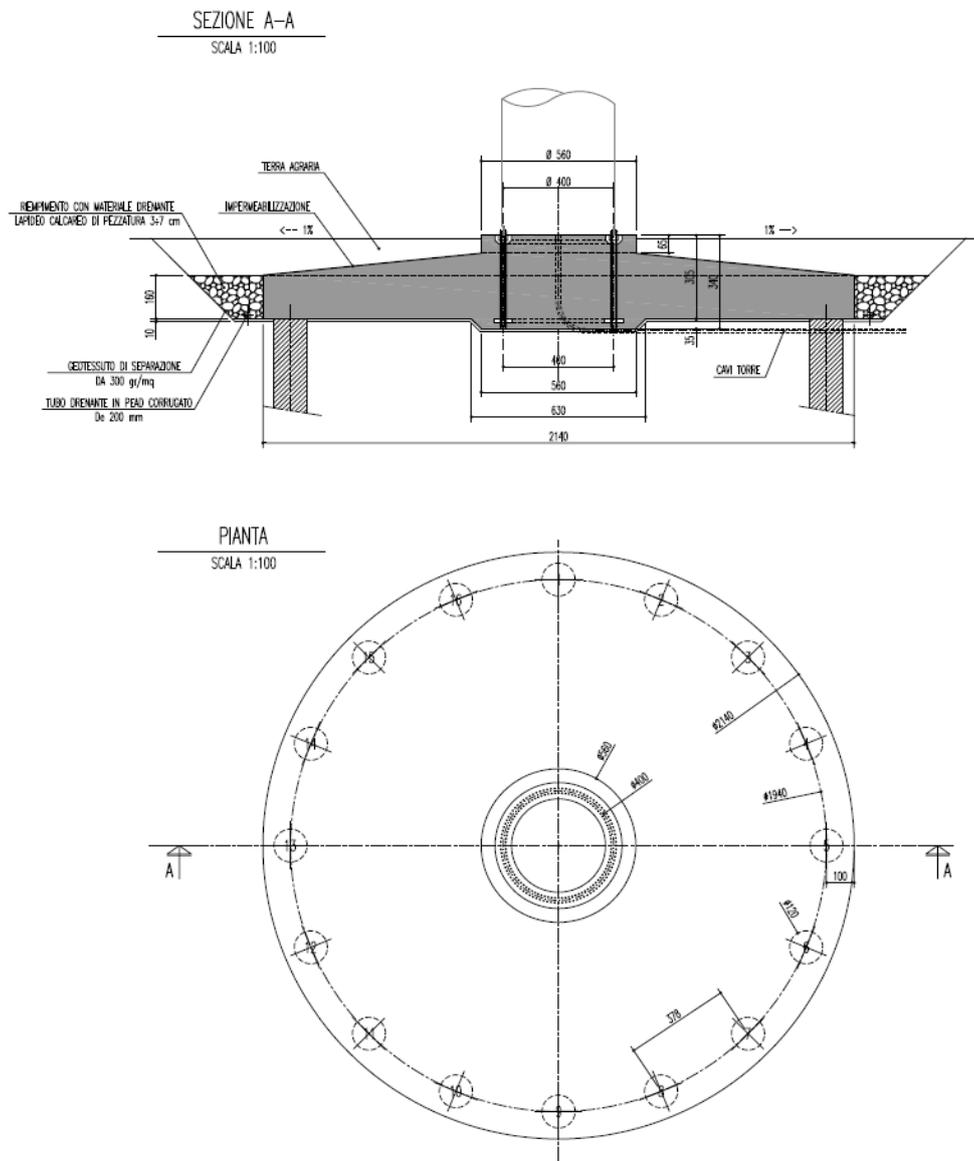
Tipologia della fondazione su pali prevista
